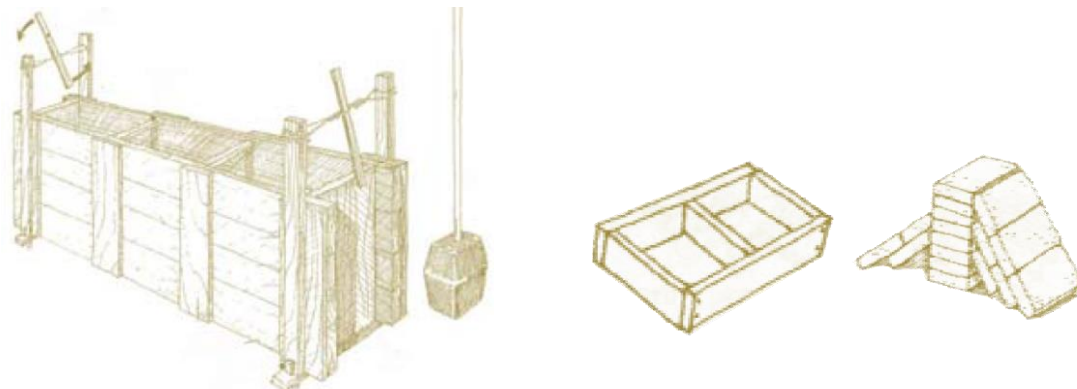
Tapial y adobe. Fuente: <http://www.construtierra.org/documents/PanelMPrimasbajacalidad.pdf>
